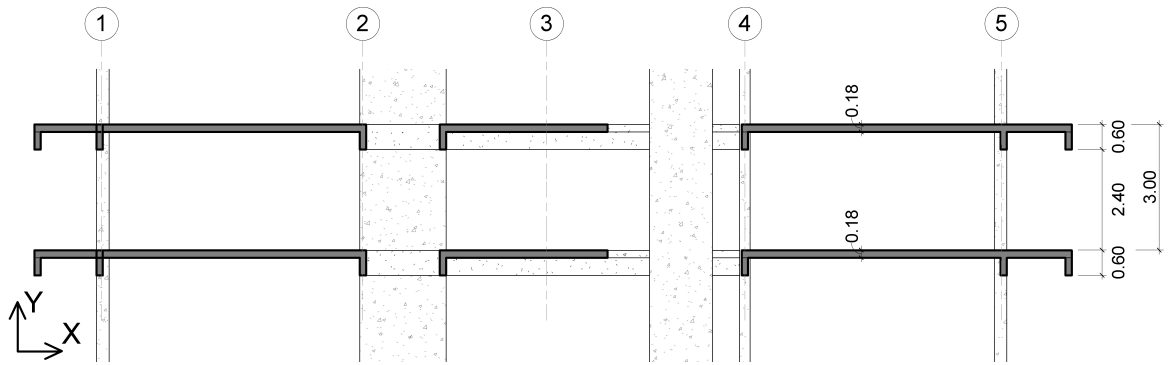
Corte A - Pavimento tipo - Modelos A e B - Unidades em metro.
